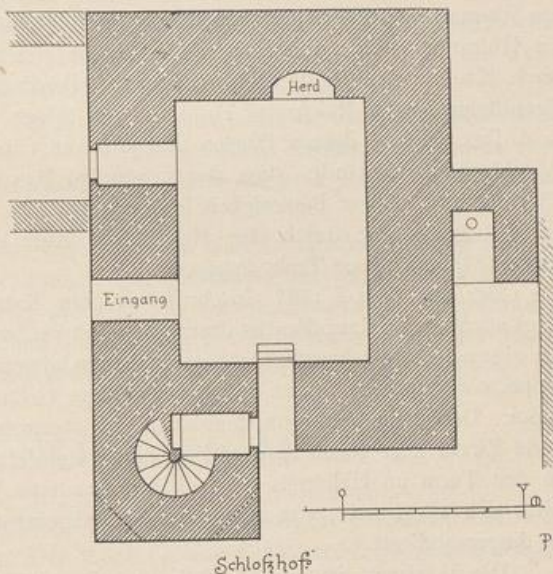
Landsberg. Grundriss des Bergfriedes.
